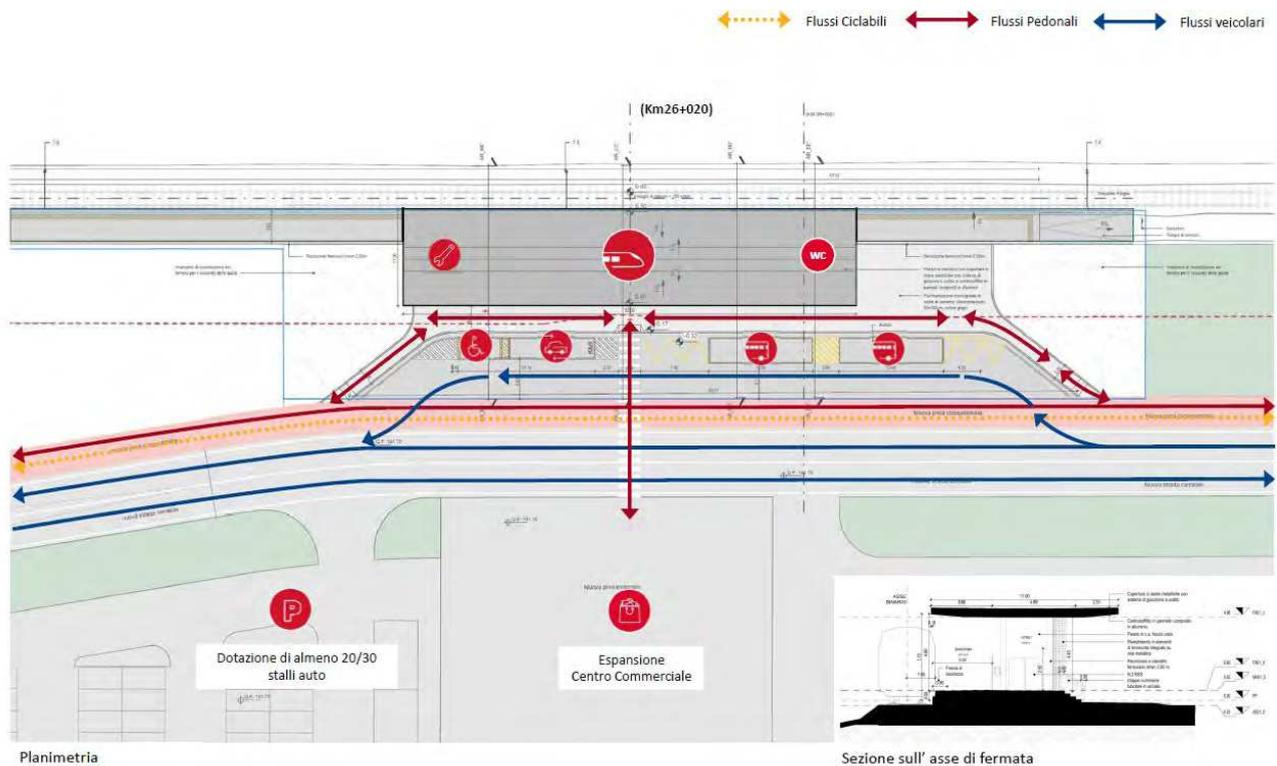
La nuova fermata di Perugia Collestrada - Aeroporto - Planimetria e sezione (Fonte: RFI)
